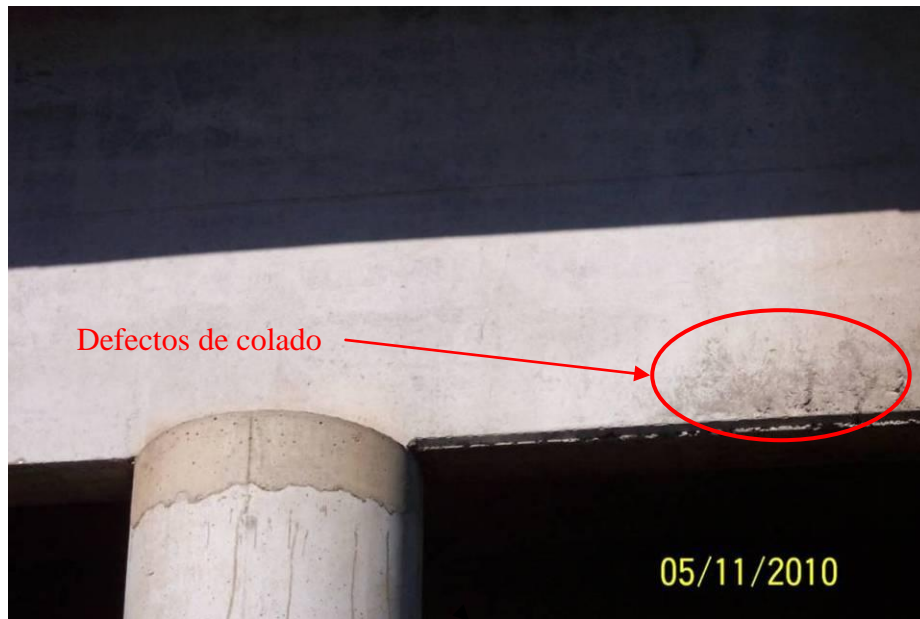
Detalle de defecto de colado en viga 2 del tamo 41.
